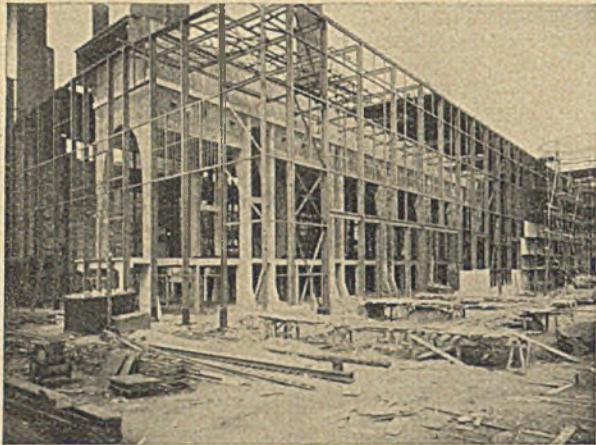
Großkraftwerk Golpa-Zschornowitz. Erweiterungsanlagen 1926. Gesamtansicht. Montagebild des Kesselhauses in Eisenfachwerkskonstruktion mit Eisenbeton-Kohlenbunker.
